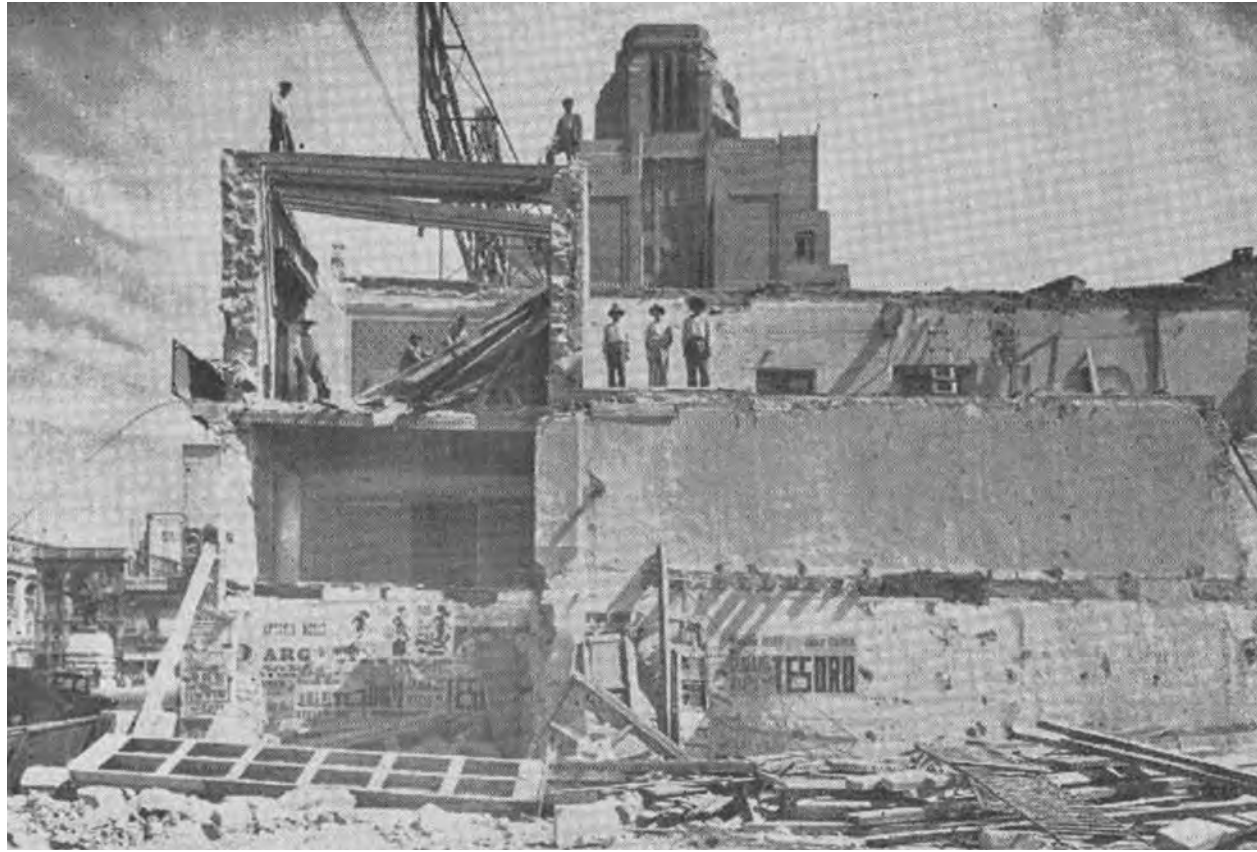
Revista planificación, tomo III, números 3 a 7. "Esquina de la Avenida Juárez y primera calle de López (durante la demolición)", 1935. (Fotografía)
